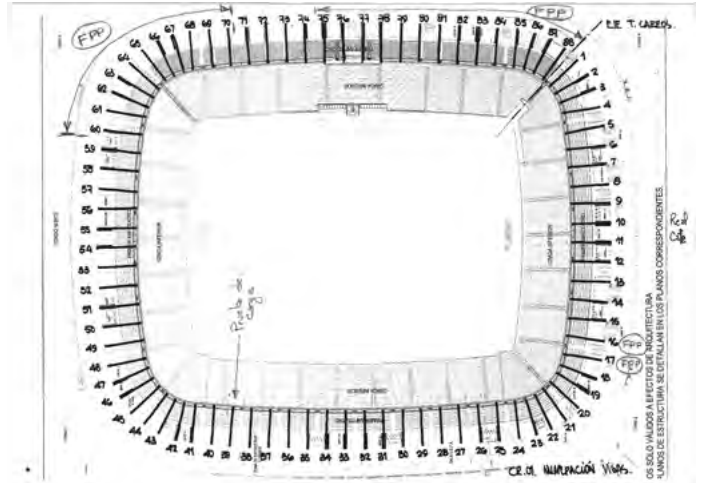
Planta estructural del primer anfiteatro. Situación de los 88 pórticos.
